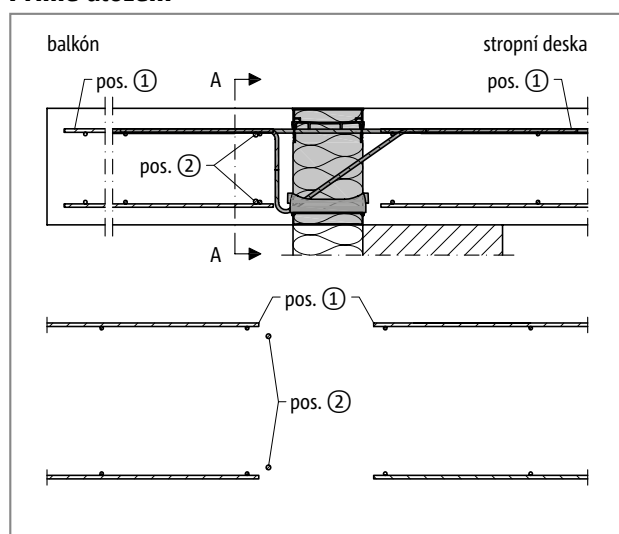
Schöck Isokorb® typ KXT45-VV: Půdorys prvku
